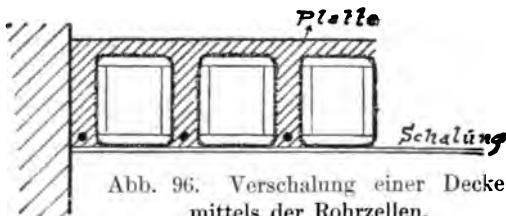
Verschalung einer Decke mittels der Rohrzellen.
